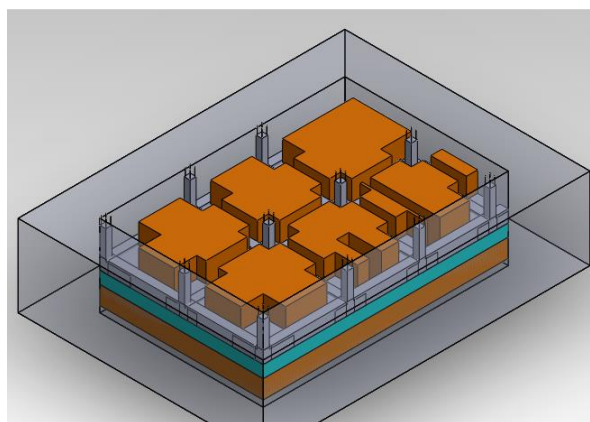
Vaciado de concreto en vigas de cimentación y zapatas.
